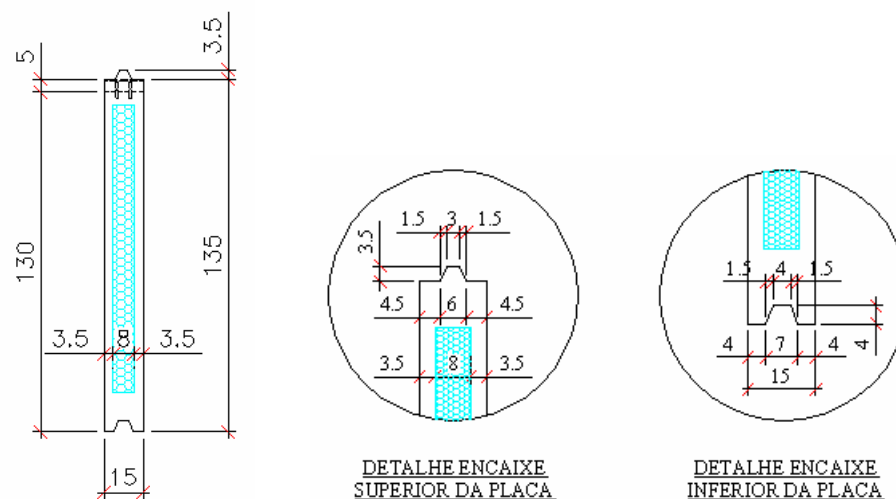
Corte transversal e detalhes de um painel pré-fabricado do tipo sanduíche.
